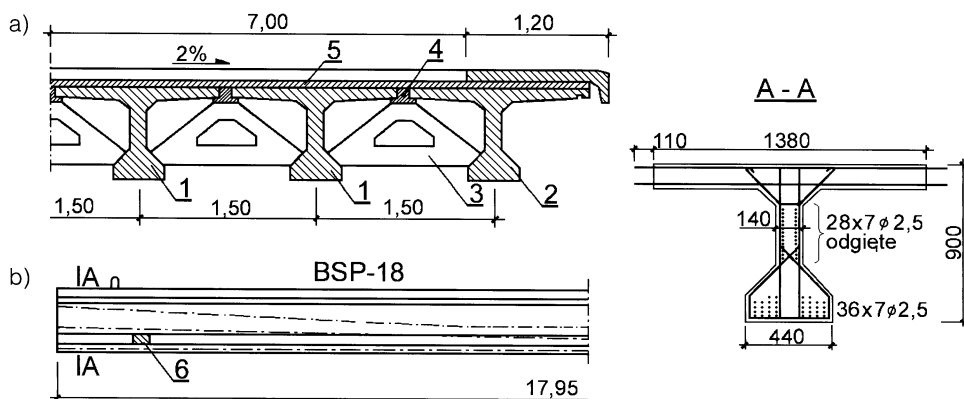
Belki kablobetonowe WBS: a) przekrój poprzeczny mostu rozpiętości 15 lub 18 m, b) widok i przekroje belki dla rozstawu podpór 15 m
